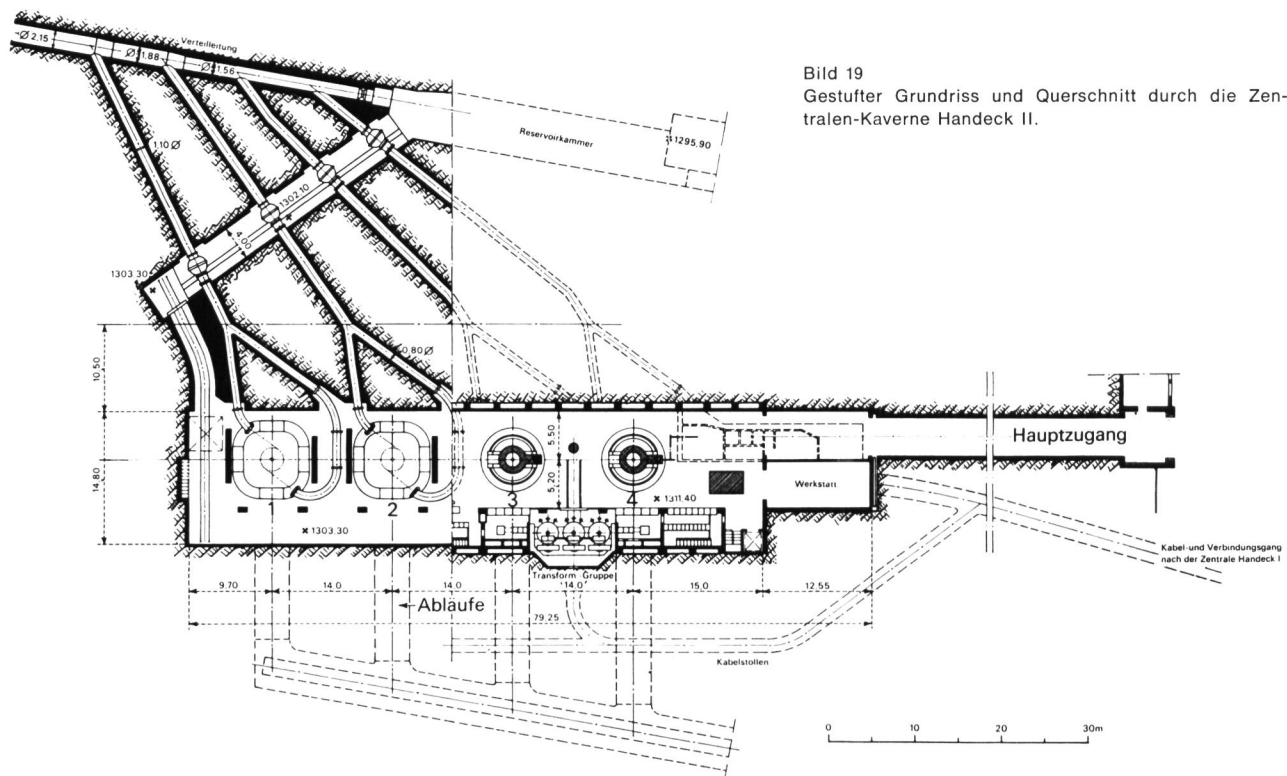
Gestufter Grundriss und Querschnitt durch die Zentralen-Kaverne Handeck II.
